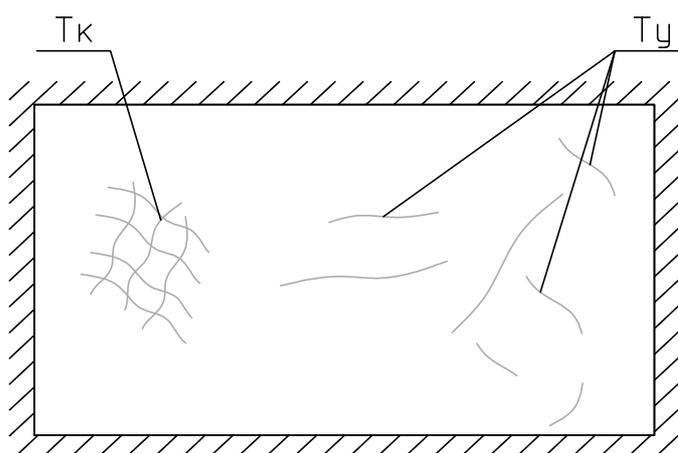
Трещины на потолочной поверхности плиты перекрытия, образовавшиеся от усадки бетона и коррозии арматуры: [4]:
